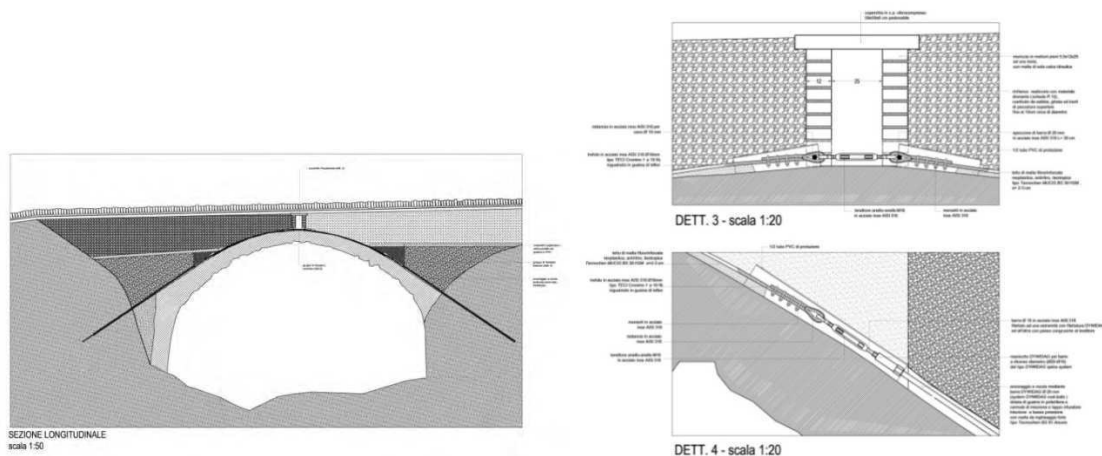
Sezione longitudinale del ponte consolidato e dettagli d'ancoraggio dei cavi.
